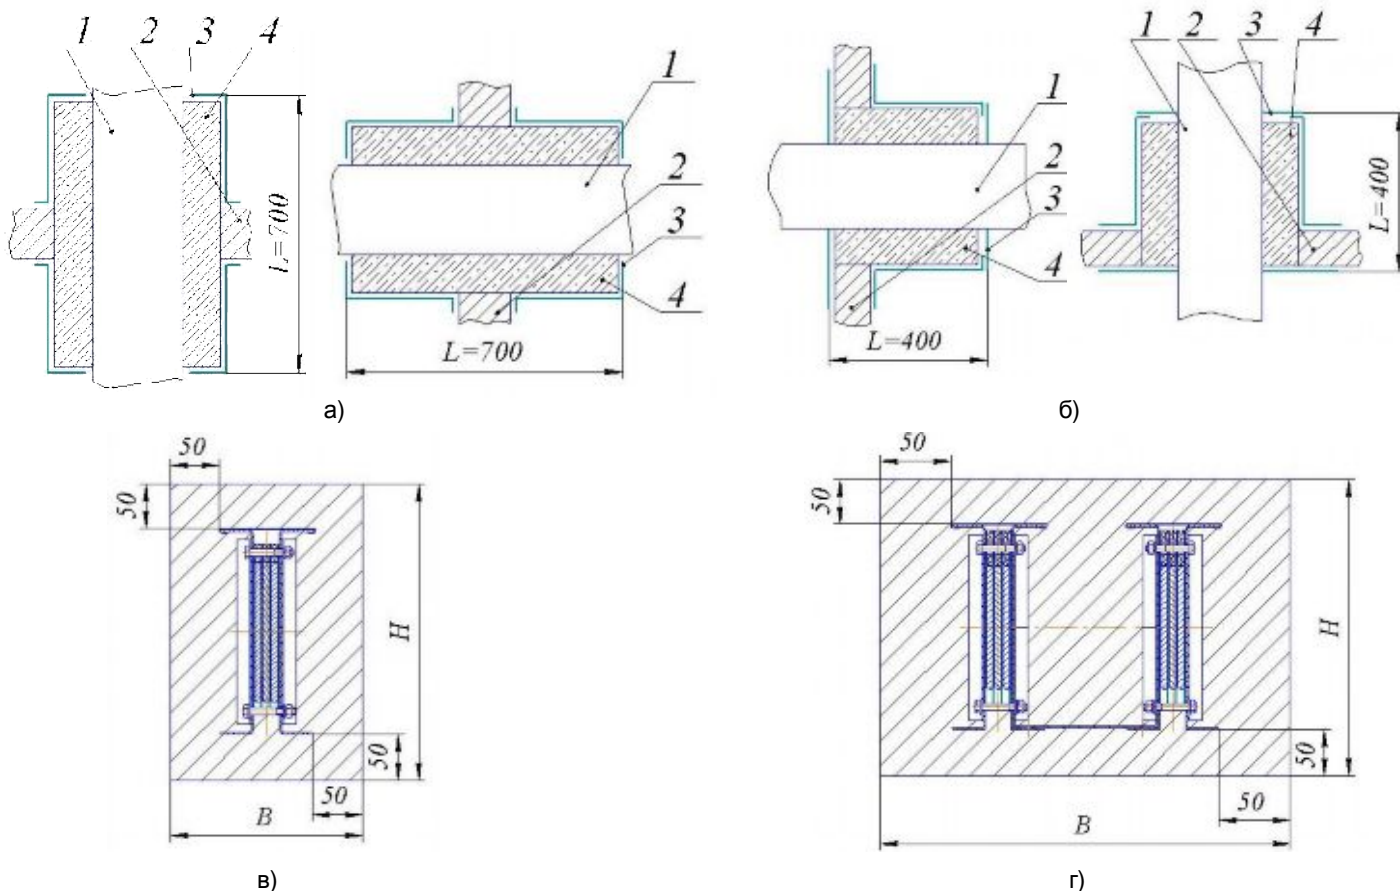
Крепление для вертикальной установки и крепление напольное
